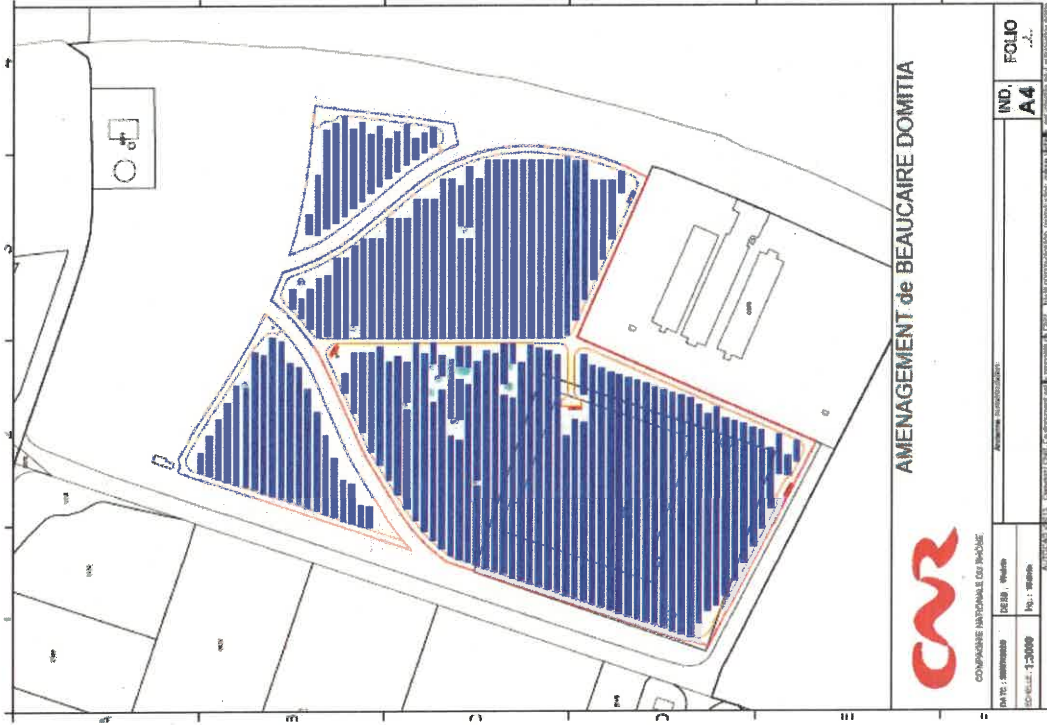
Plan de masse de la variante 2 (juillet 2020)
